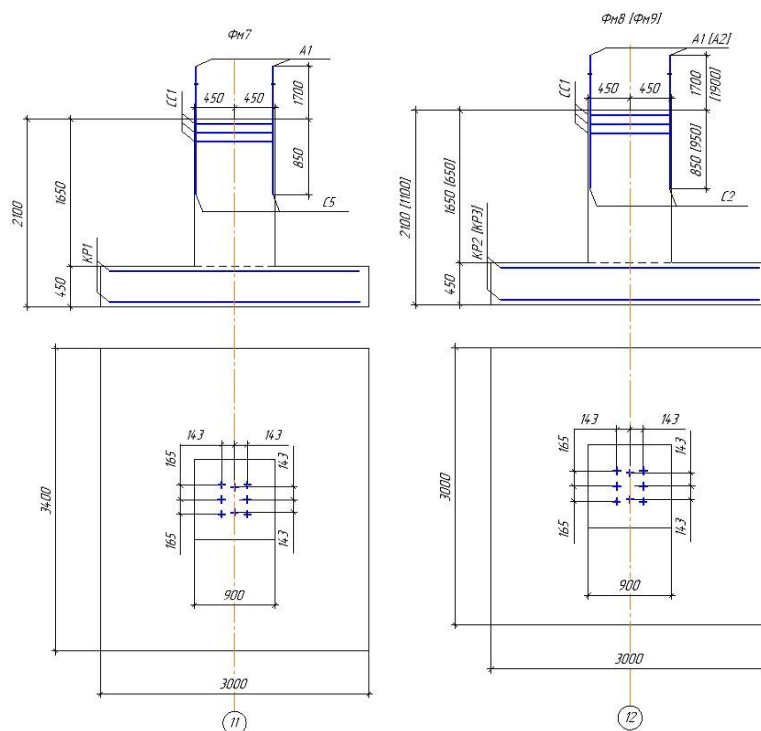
Схема расположения арматурных изделий в фундаментах Фм7, Фм8 и Фм9
